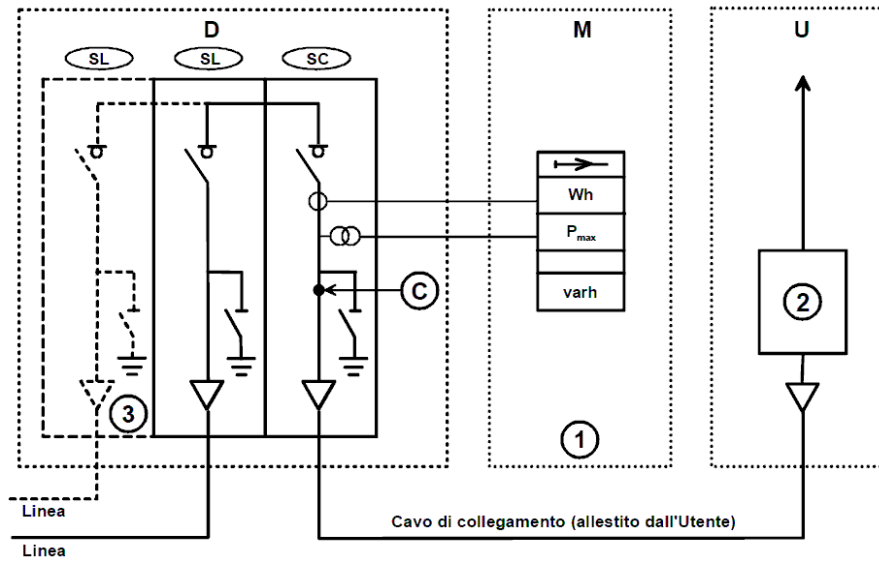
Schema di collegamento fra la cabina consegna e impianto di Utente passivo
